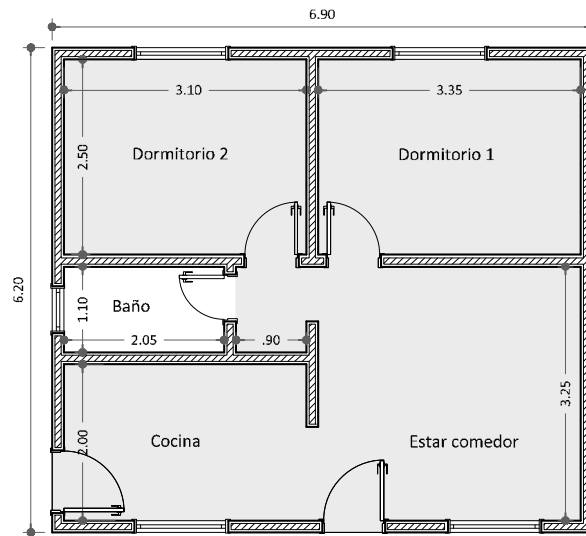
Planta baja del Caso II: vivienda unifamiliar.
